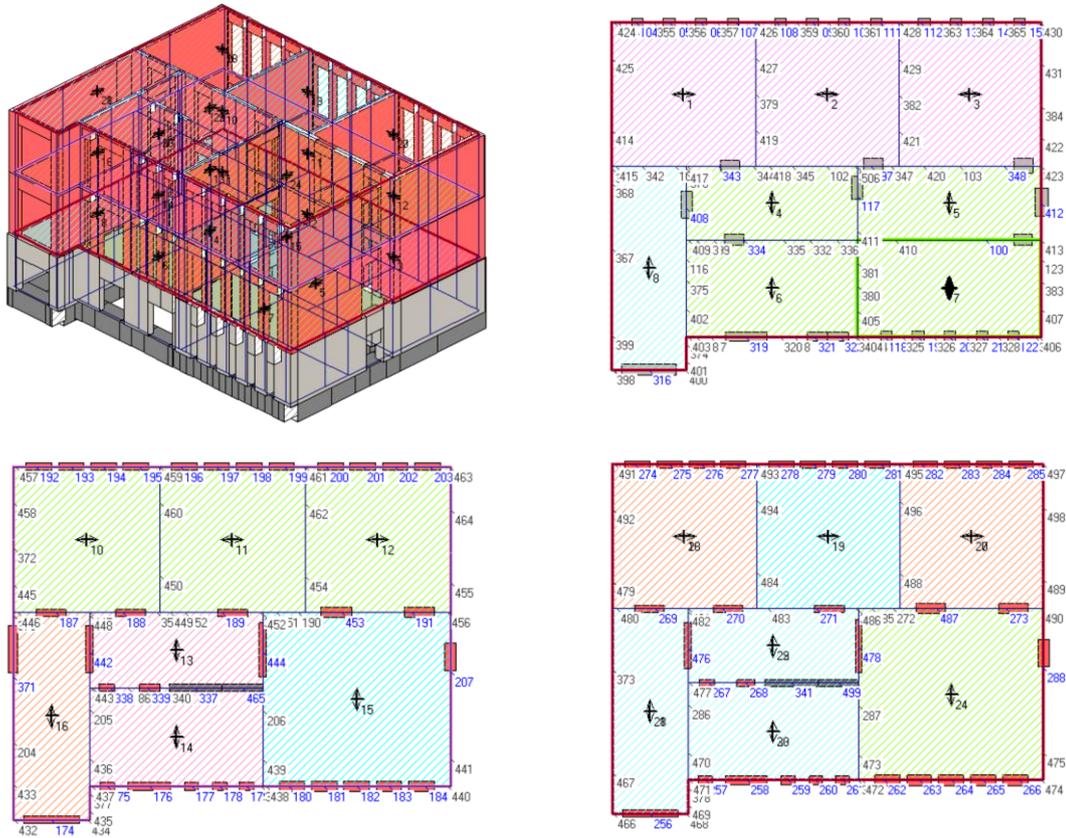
In alto a sinistra: modellazione parte originaria struttura. In alto a destra: Pianta solaio piano terra. In basso a sinistra: Pianta solaio piano primo. Ogni pianta presenta i centri di massa. Fonte: Comune di Cesena
